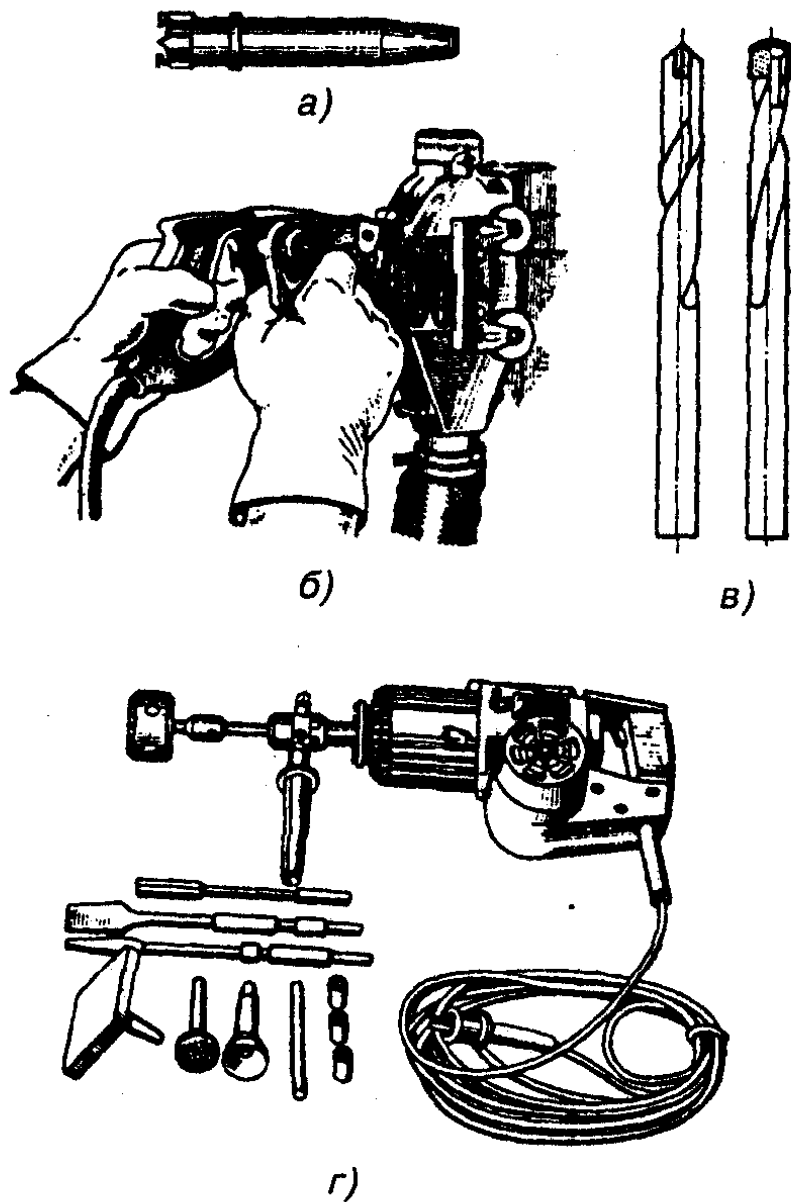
Инструмент, механизмы и приспособления для пробивных работ:
